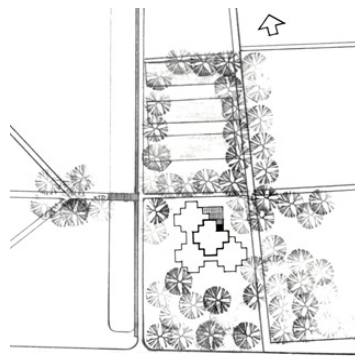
Plano de situación: geometría ideal en un claro del bosque.
